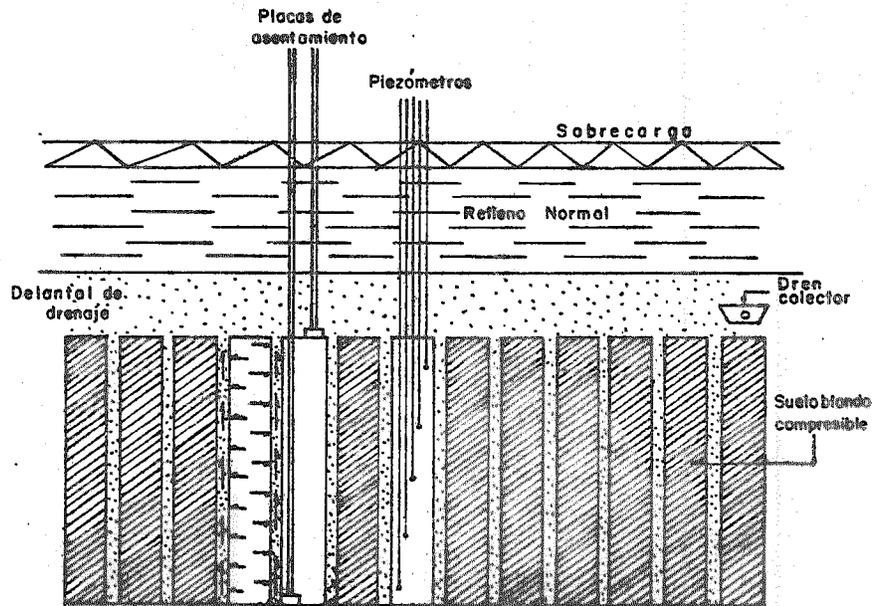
Perfil de una zona tratada con drenes.
